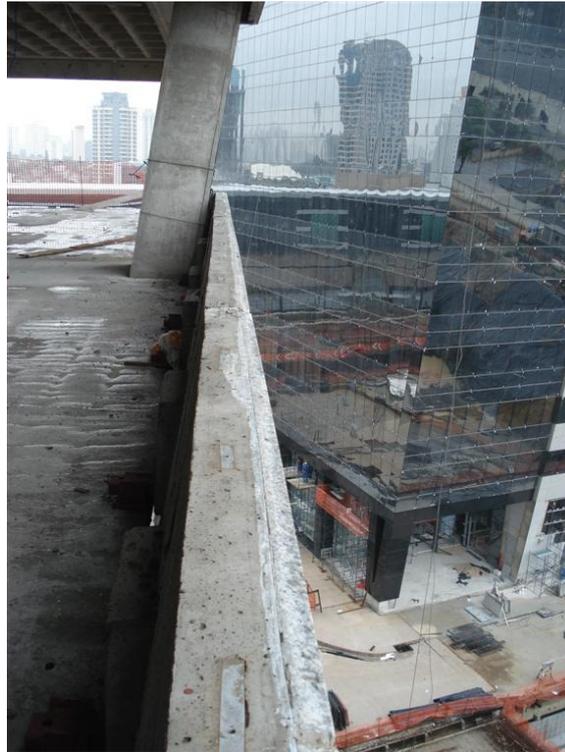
Painel de concreto pré-fabricado instalado na fachada inclinada
